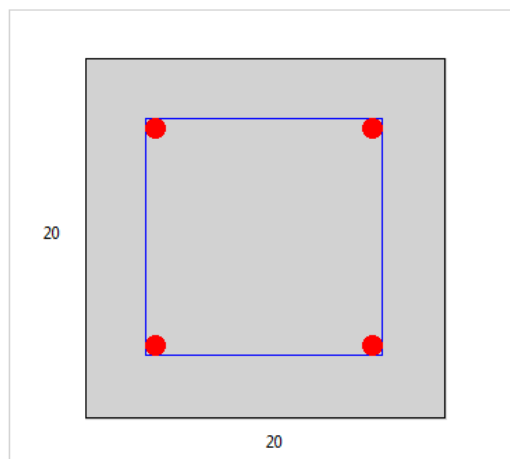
Pilar P1 - Dados para detalhar a seção transversal
